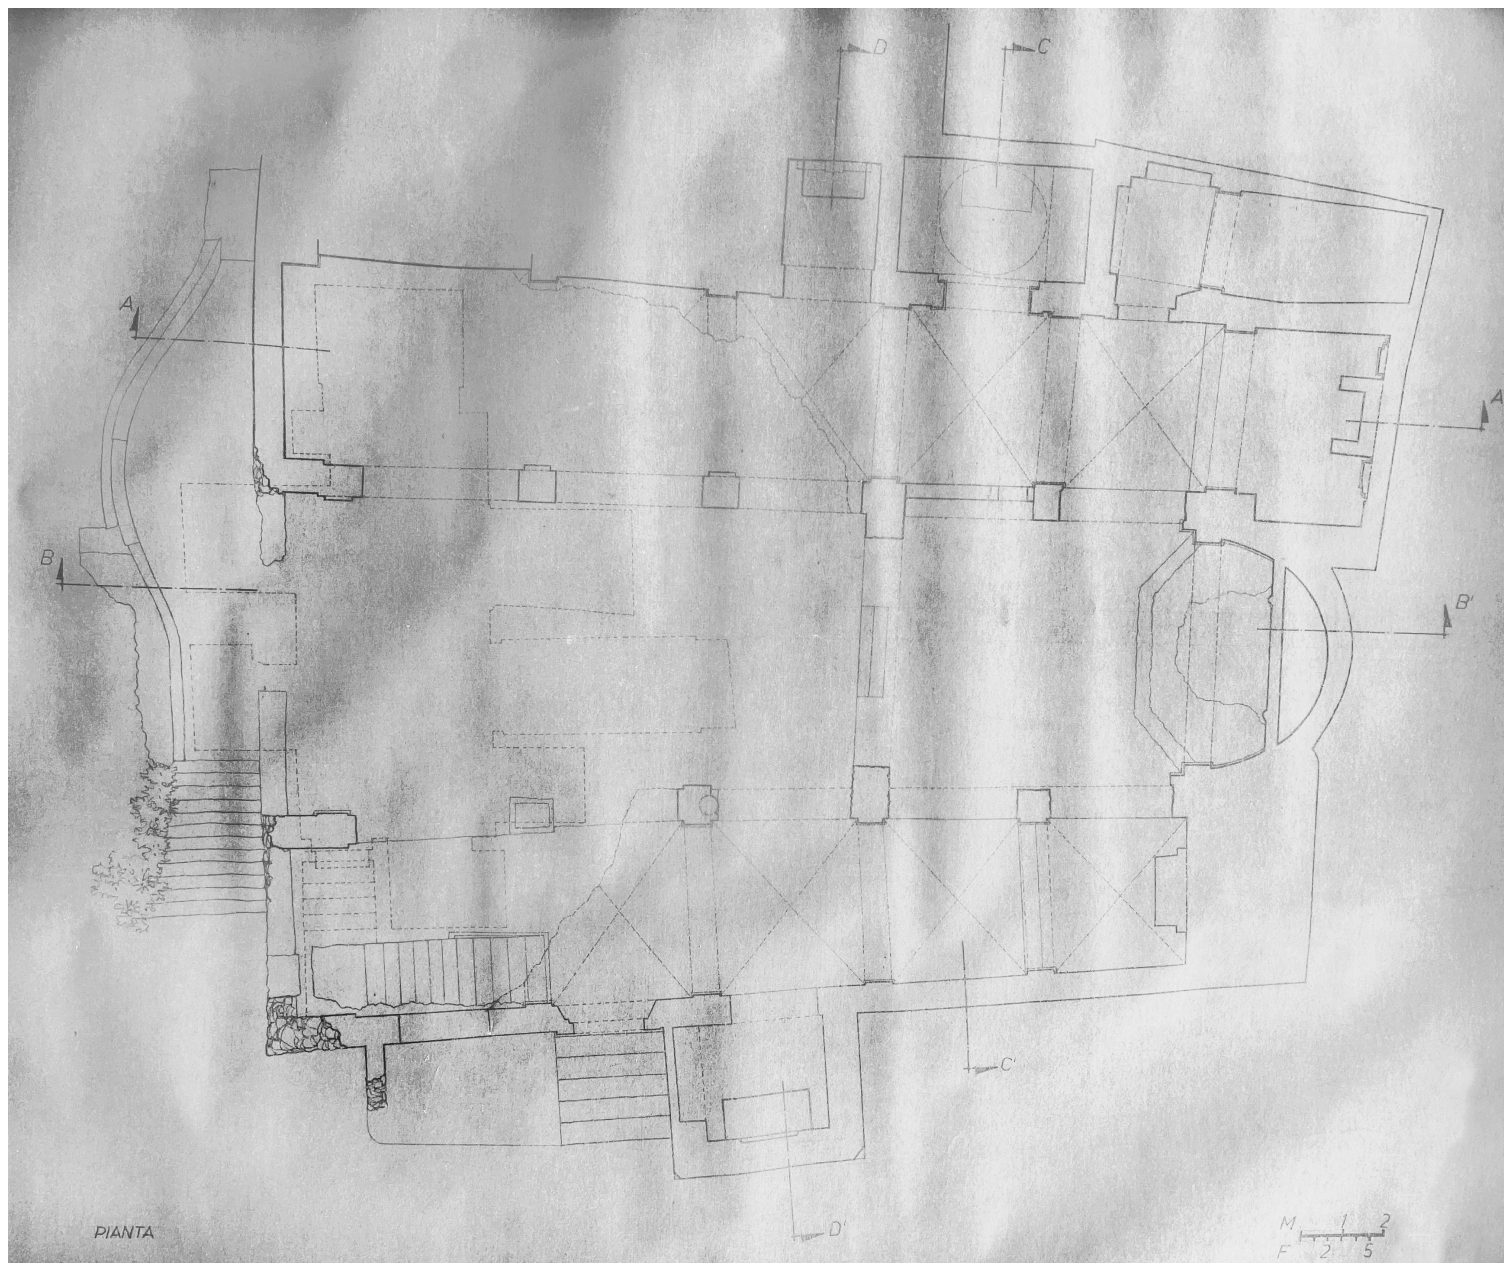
Ezio De Felice, pianta di rilievo della Cattedrale (Fondazione Ezio De Felice, Archivio disegni, faldone 79).
